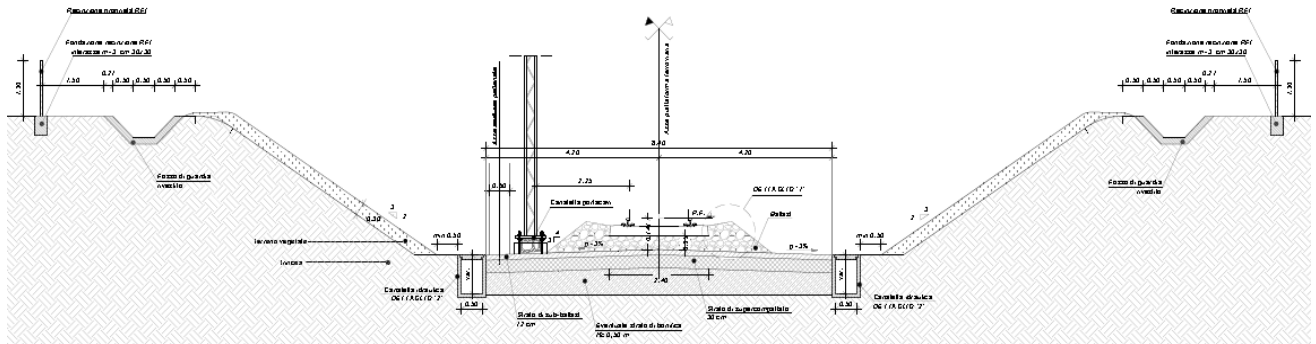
Sezione tipo ferroviaria in trincea a singolo binario in rettilo
